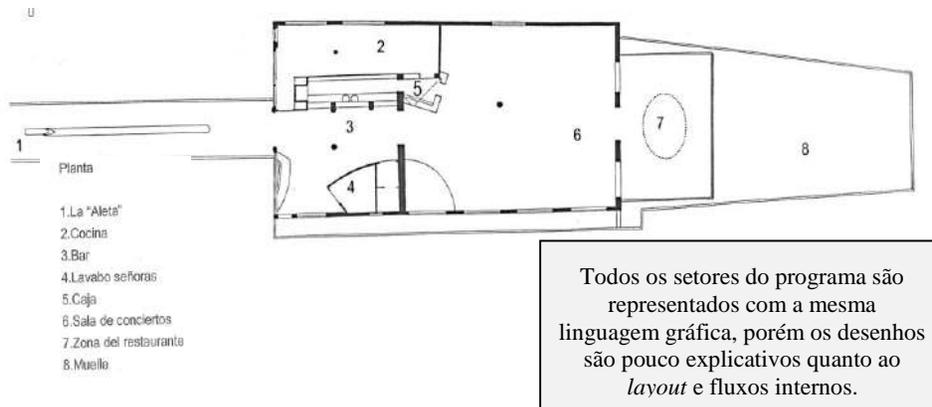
Planta baixa de um Bar e Restaurante em Follonica, Italia.
